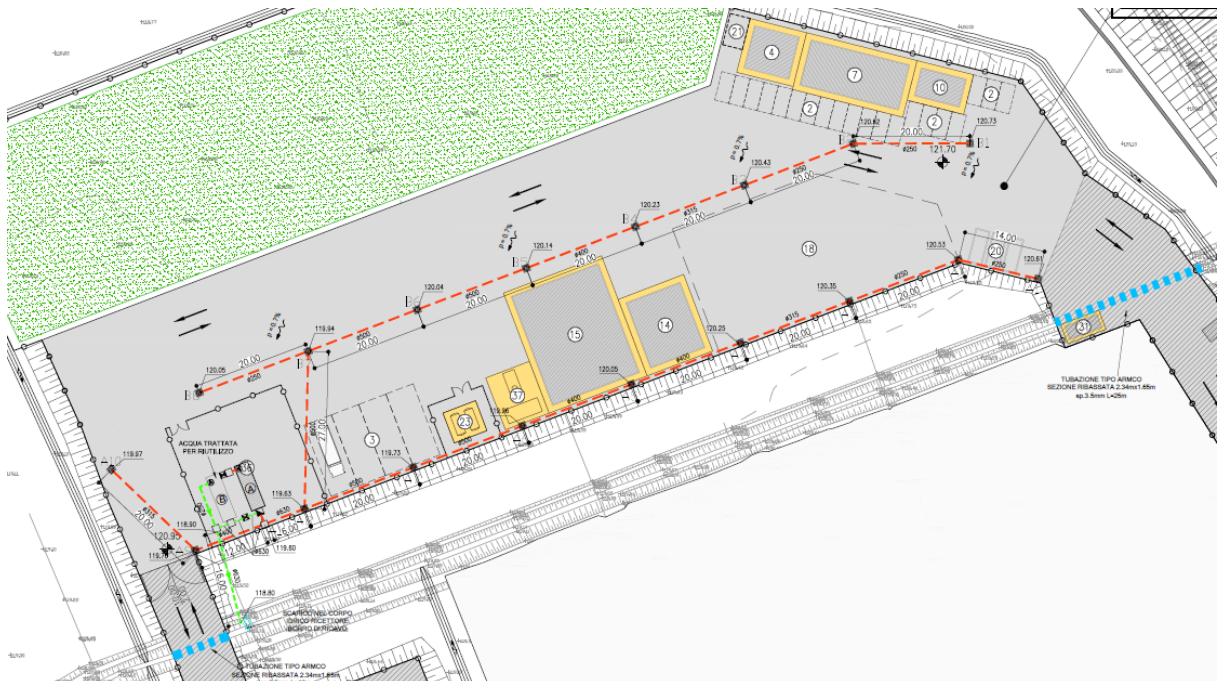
Planimetria reti idrauliche del CO01 – Cantiere operativo
